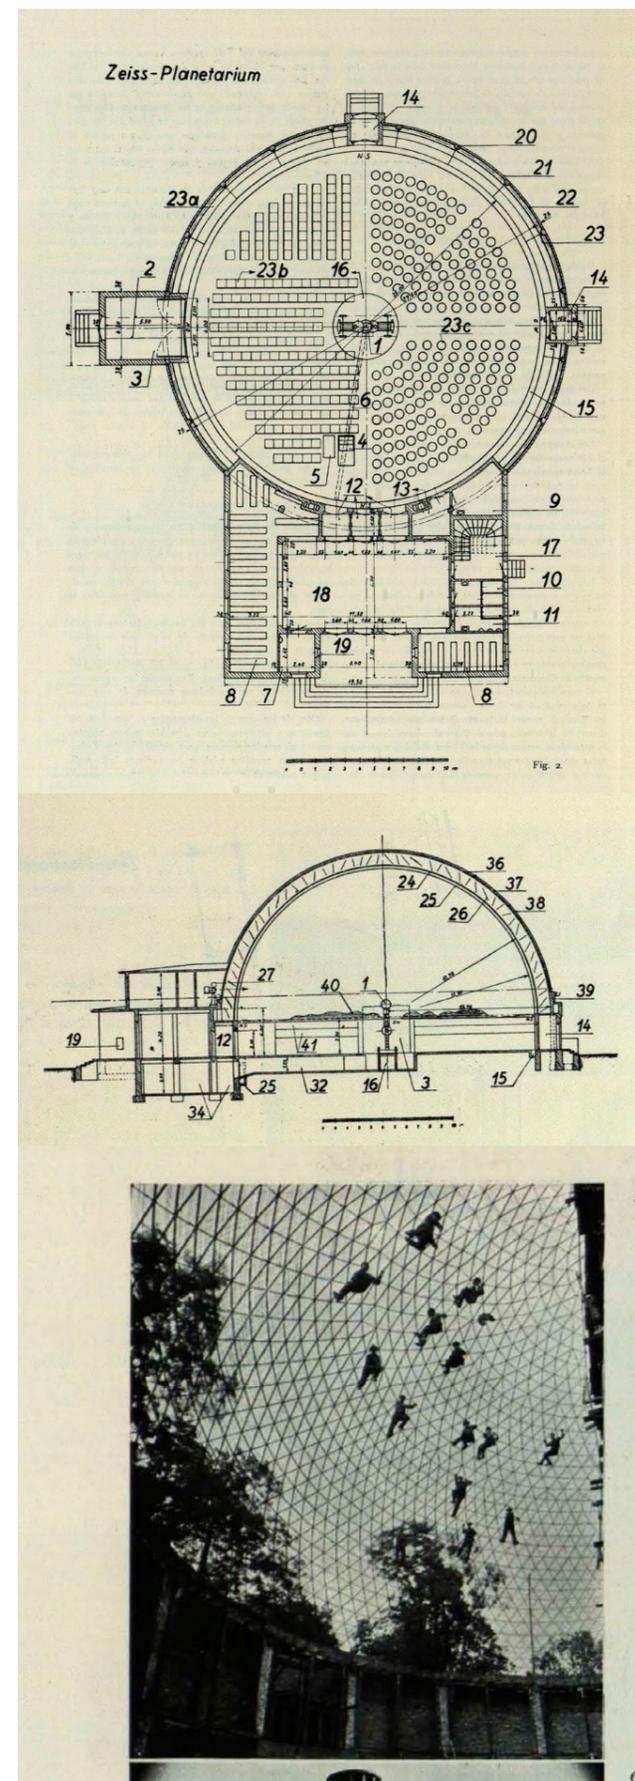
Planimetría, Planta y corte de Planetario Jena, Imagen de la construcción de la cúpula geodésica.
